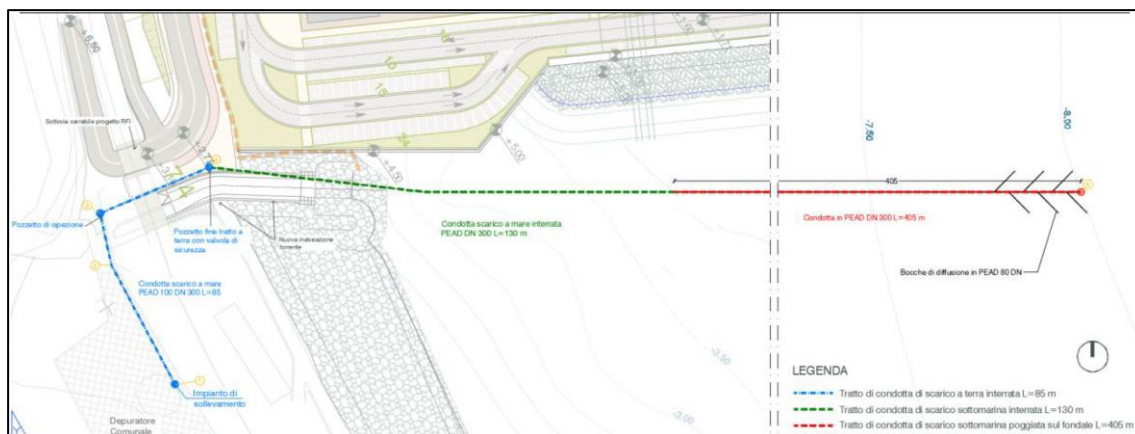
Schema planimetrico del ripristino della condotta sottomarina.
